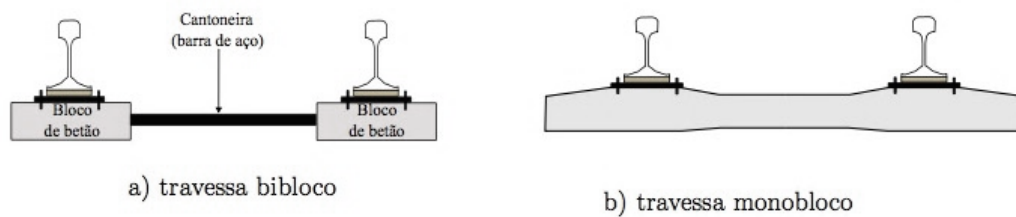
Tipos de travessas de betão (Vale, 2010).
